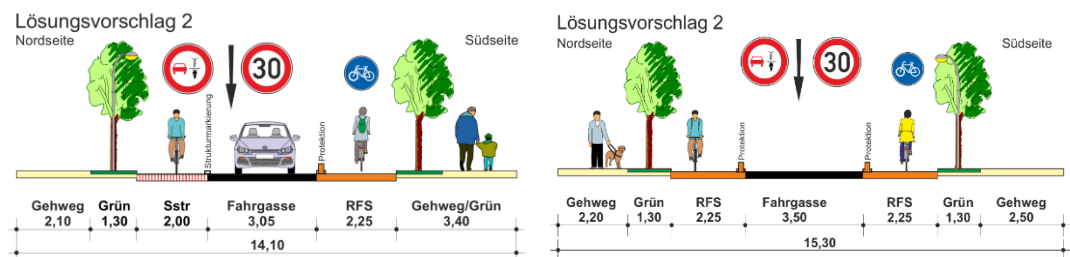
Beispielhafter Querschnitt im Abschnitt Umfassungsstraße und Lübecker Straße (links) sowie im Abschnitt Lübecker Straße und Nachtweide (rechts)
